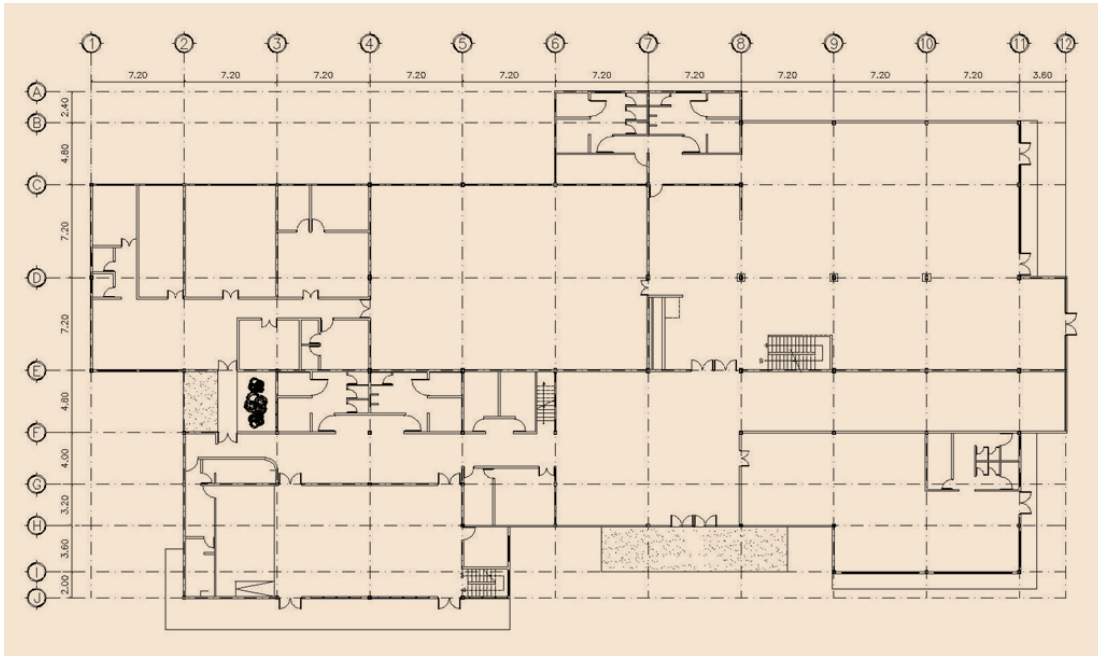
Modulación ejes estructurales en la planta arquitectónica.
